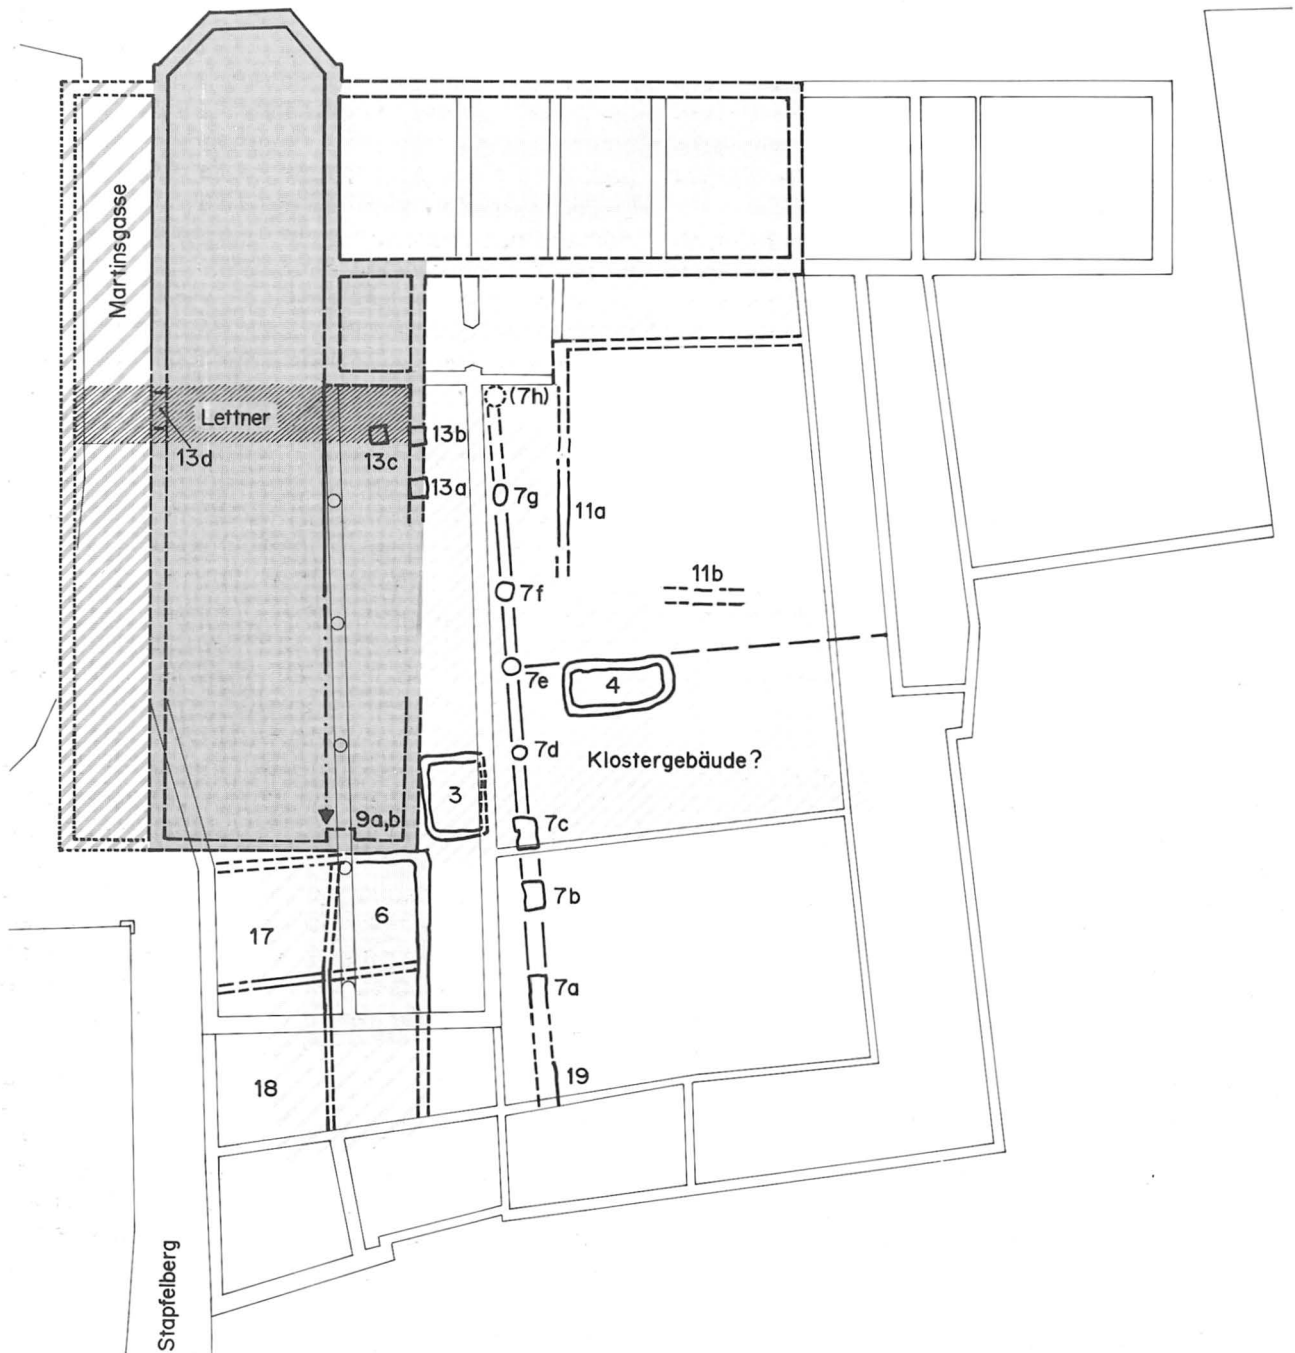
Grundriss des Klosters um 1280/90 (Kirche Ia). Rekonstruktion. Die Schraffuren deuten Wahrscheinlichkeitsgrade an. – Massstab 1:400.
